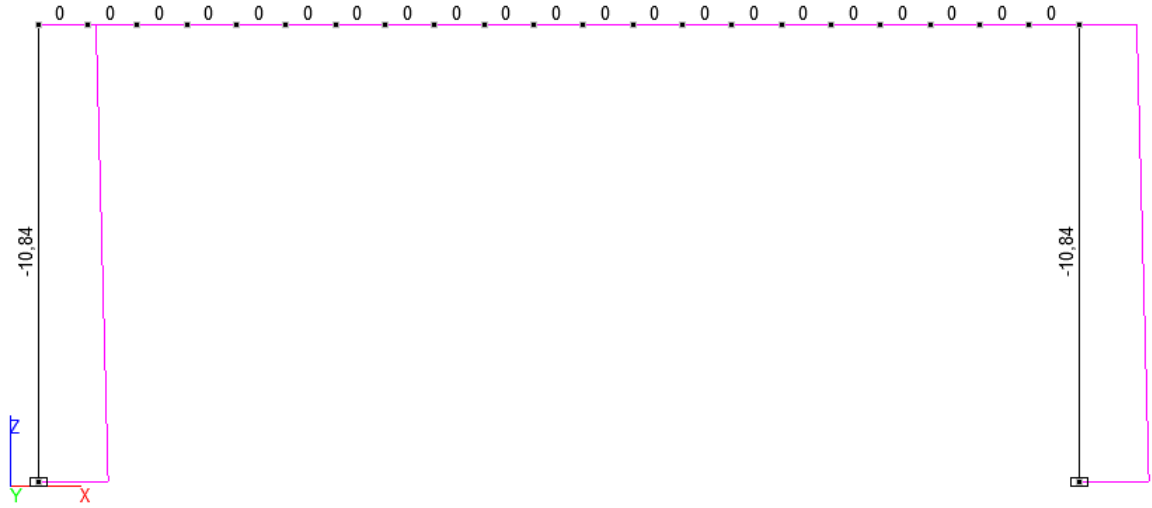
Расчетная схема нагрузки от собственного веса и покрытия
